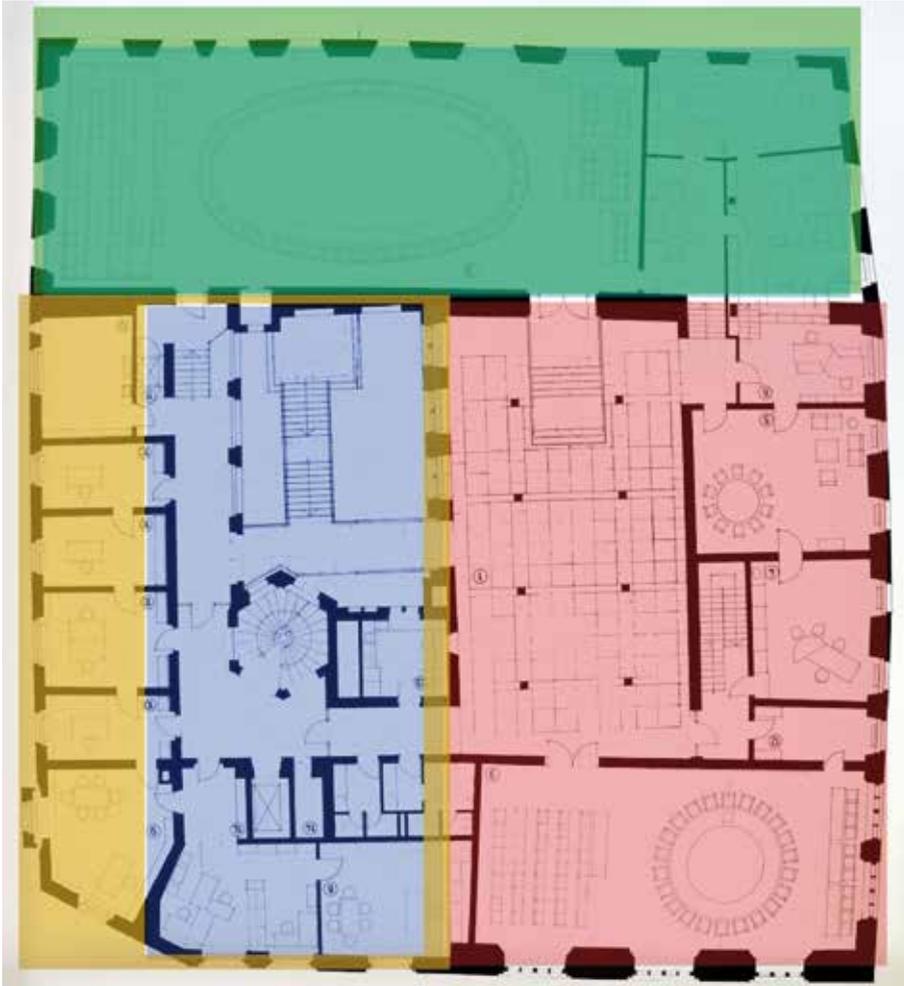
Grundriss Ulmer Rathaus, 2. OG (Stadt Ulm, Abteilung Gebäudemanagement; farbige Markierung: Dorothea Mengele).
